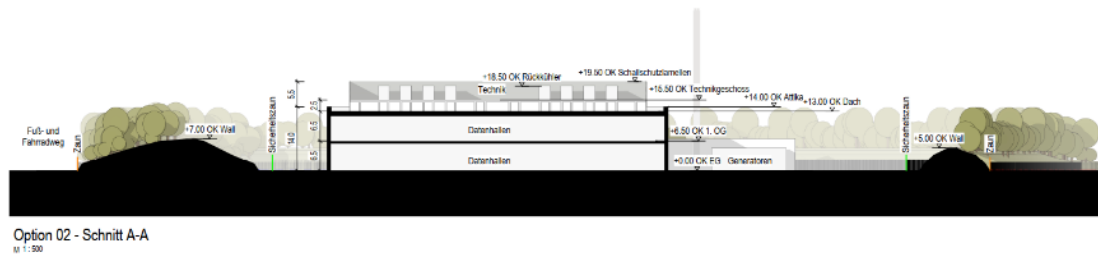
Skizze Wall mit Bepflanzung Geltungsbereich A ²⁹
